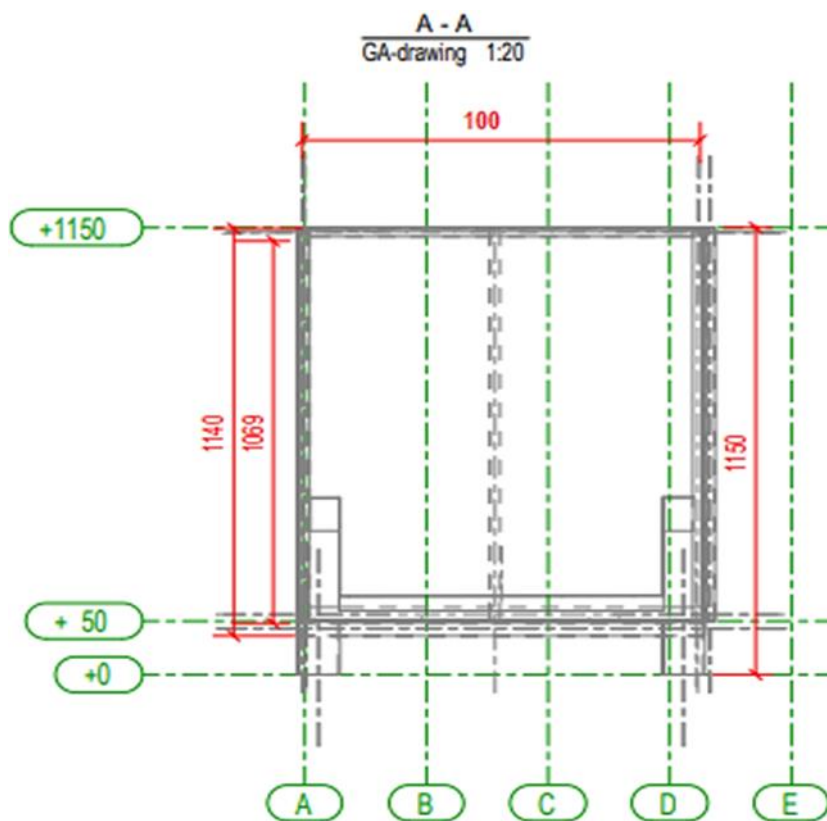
Corte transversal do projeto do canal (dimensões em mm)
